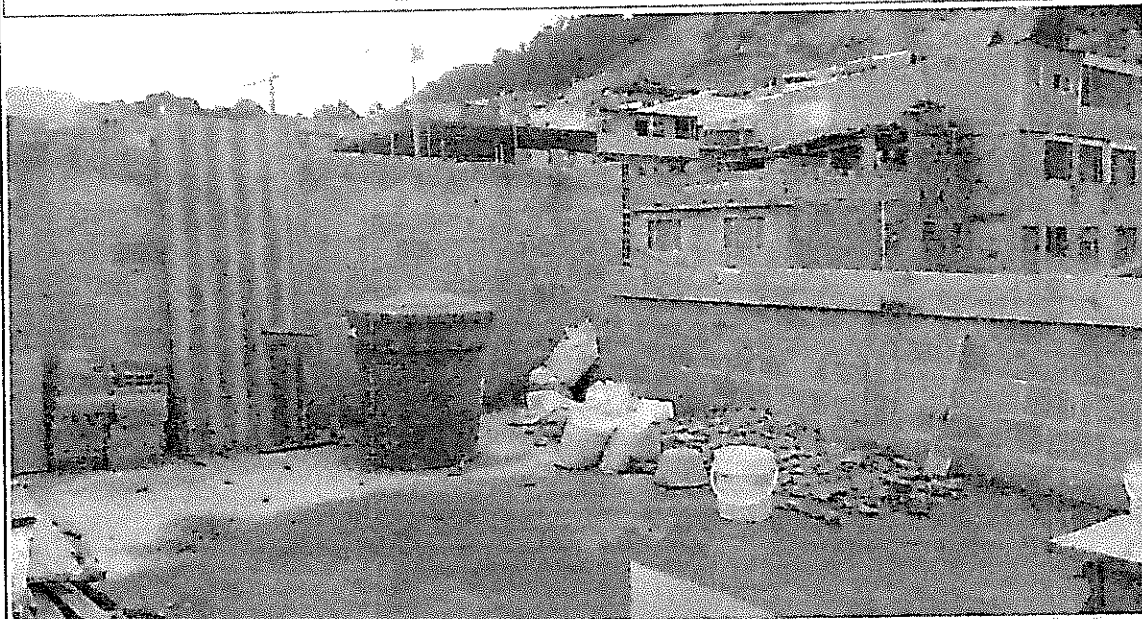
CONSTRUCCION DE MUROS LATERALES.
